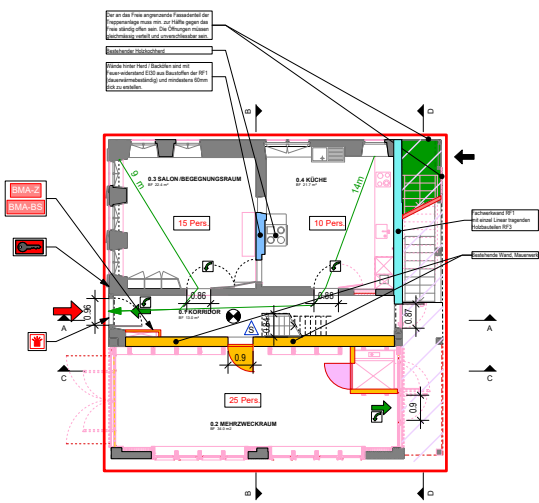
Grundriss EG Brandschutzkonzept
